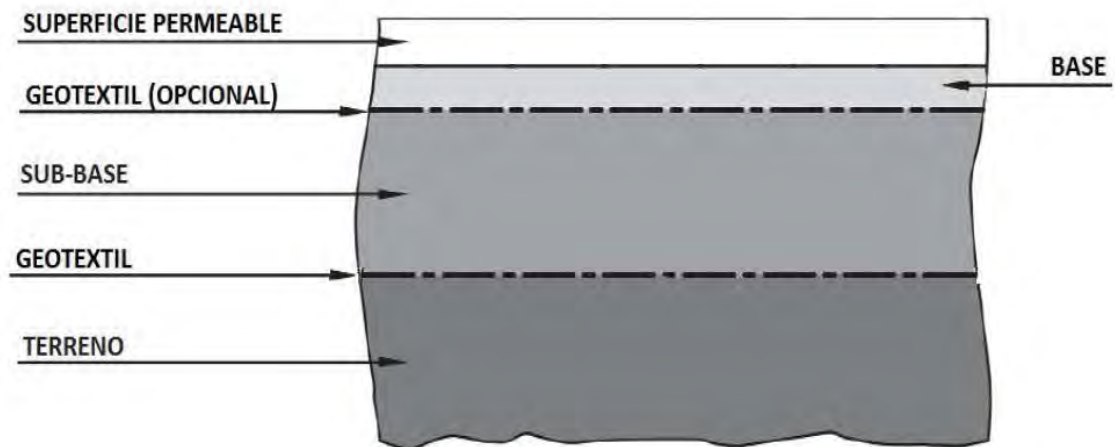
Sección transversal de un pavimento permeable. Fuente Woods-Ballard
